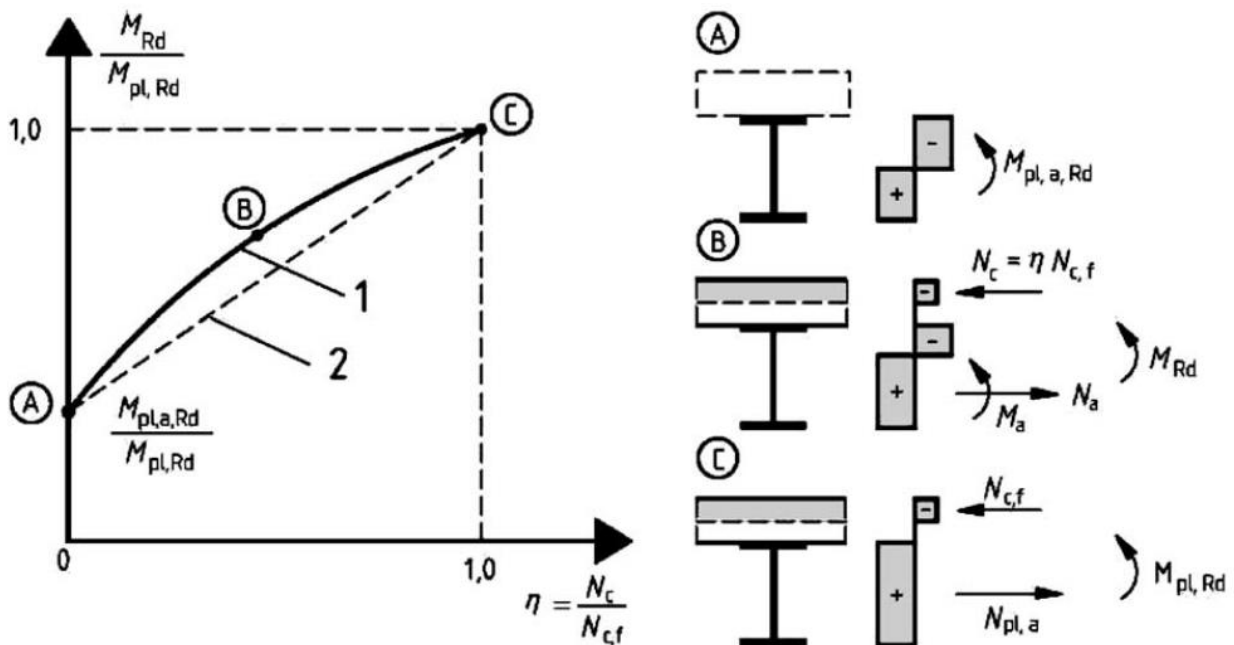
Розподіл напружень у пластичній стадії при дії додатнього згинального моменту в перерізі сталезалізобетонних балок із частковим з'єднанням
